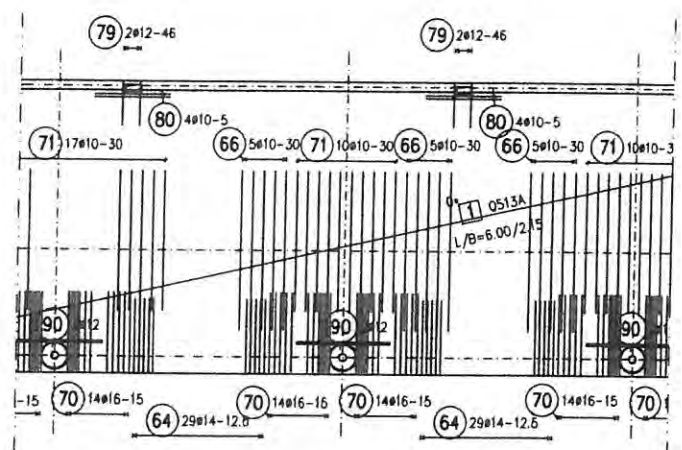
Variante 3: Deckenausschnitt konventionelle schlaffe Bewehrung, untere Lage: $d = 30$ cm, Beton C 25/30 XC1, Durchbiegung 4,5 cm
